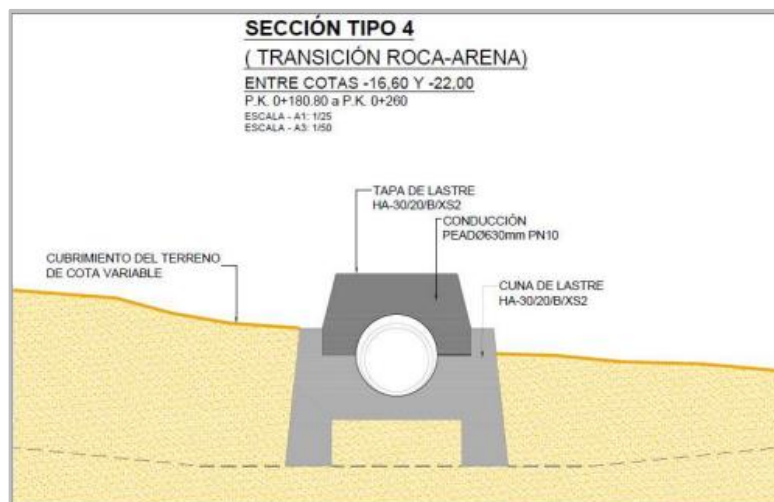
Sección constructiva de colocación de tubería y lastre continuo con patas de arena en zona de transición roca-arena.
